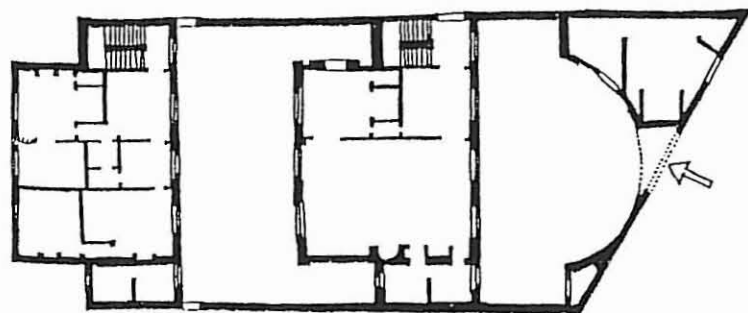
(CII) Hôtel Vassal de Saint-Hubert, rue Pigalle. Henry. 1784. Plan du rez-de-chaussée.
